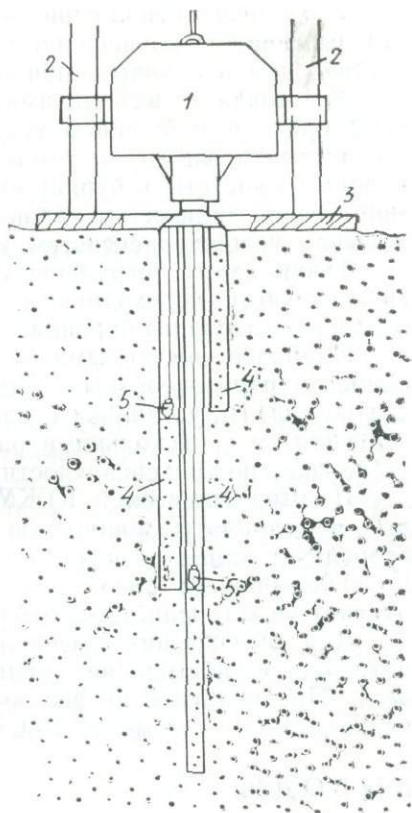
Установка для отбора керна пачкой колонковых труб, соединенных вместе с общим приводом: 1 — привод; 2 — направляющая; 3 — основание; 4 — колонковая труба; 5 — заглушка
